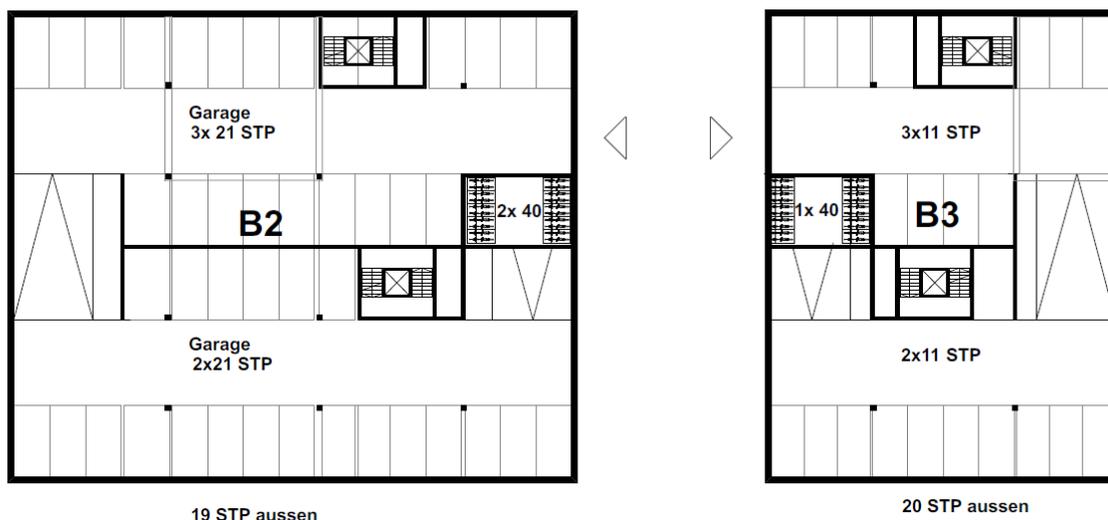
Grundrisskizze Tiefgaragen der Gebäude B2 und B3
